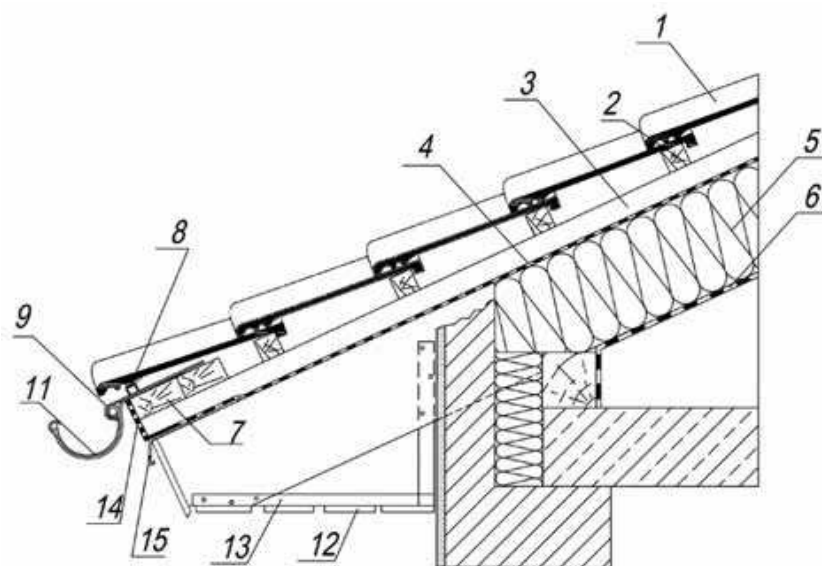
Карнизный свес с высокорасположенным жёлобом:
